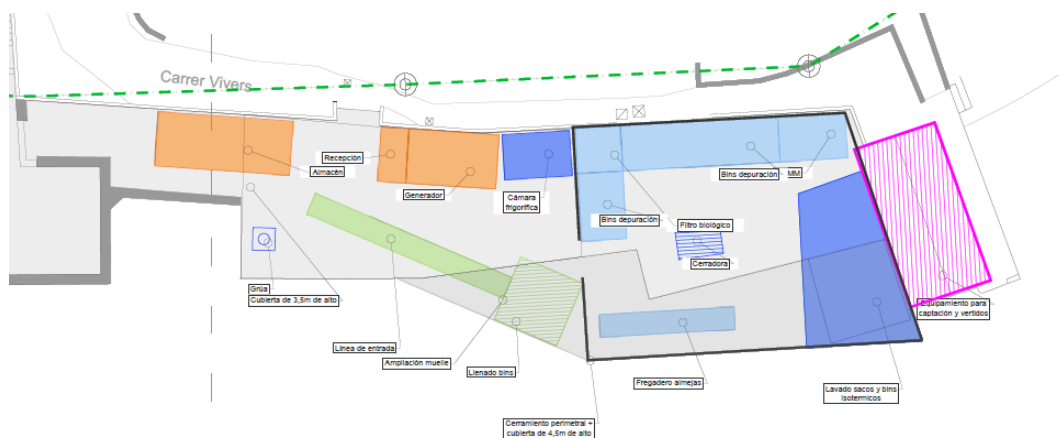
Planta propuesta para la alternativa 3 en las parcelas 8, 9 y 10.
